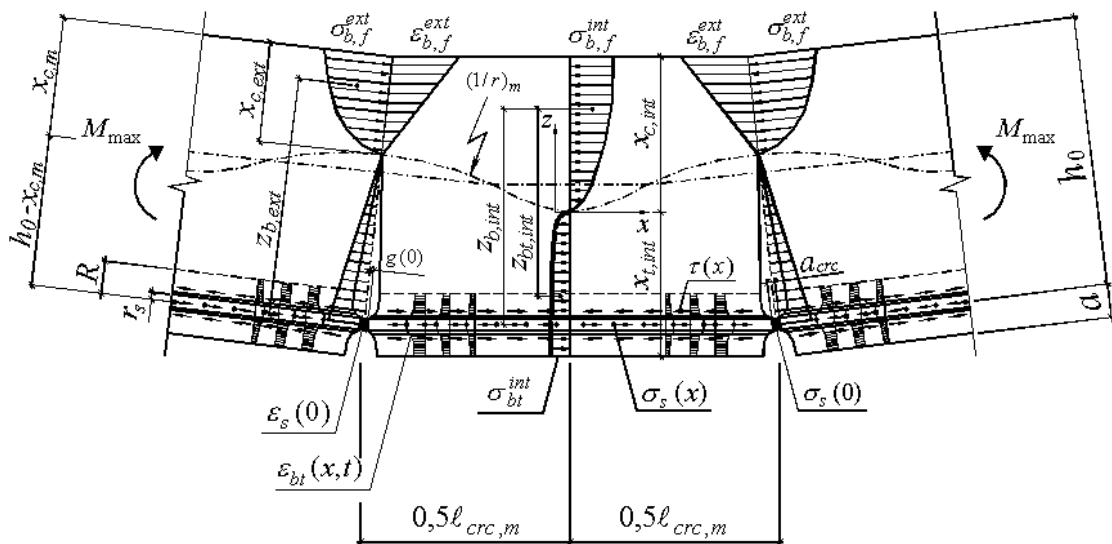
Схема напряженно-деформированного состояния железобетонного элемента в стадии с трещинами на уровне максимальной нагрузки цикла
